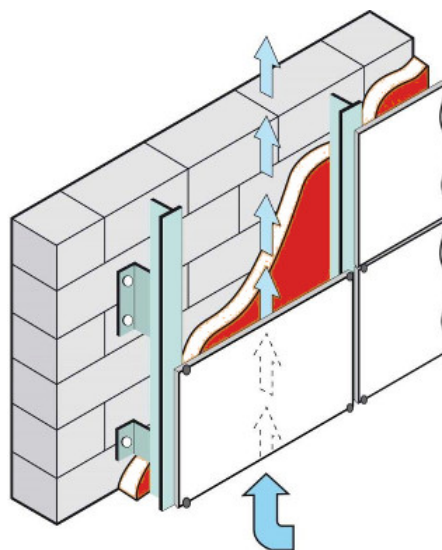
Esempio di facciata ventilata – Fonte: [www.pastoreserramenti.it](http://www.pastoreserramenti.it)
